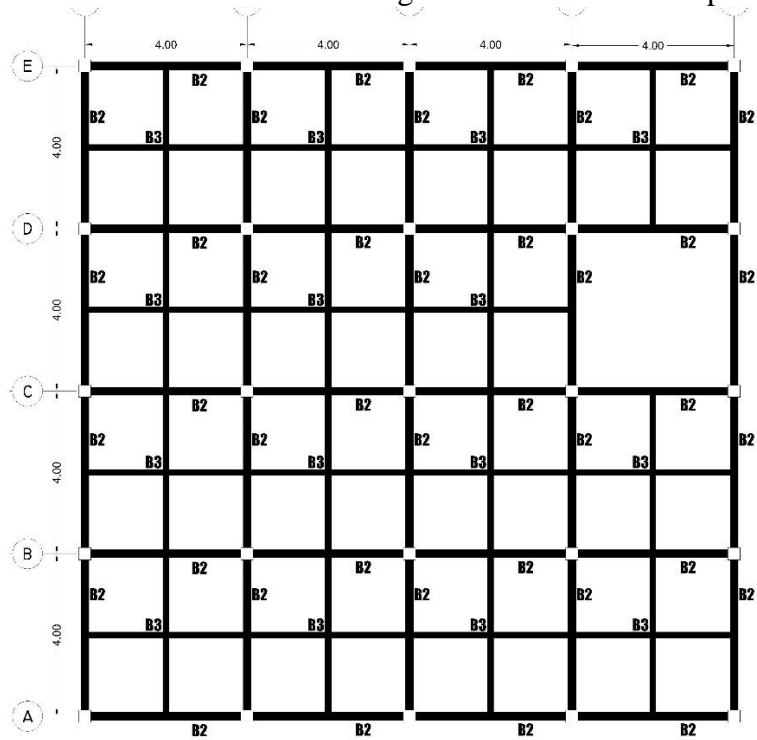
Denah Balok Lantai 1 Sampai 5
